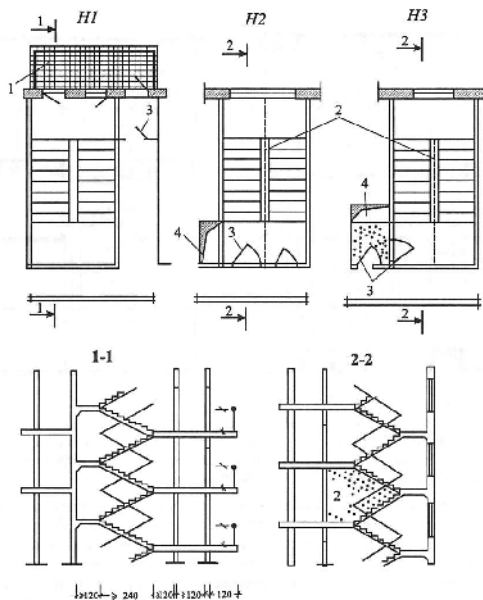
Планы незадымляемых лестничных клеток типов Н-1, Н-2, Н-3: 1 – выдувная зона; 2 – противопожарная рассечка через каждые 5 этажей; 3 – неустраиваемые двери (предел огнестойкости Е 130); 4 – шахта дымоудаления
